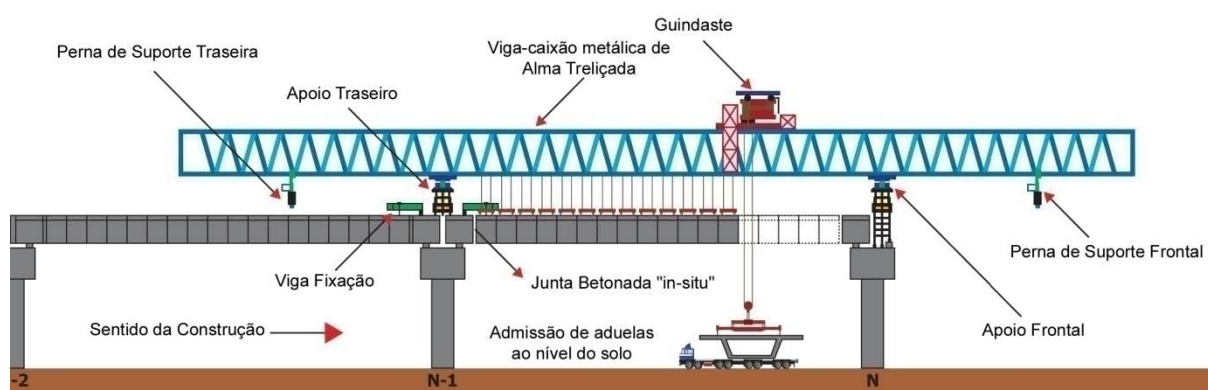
Construção tramo a tramo com recurso a lançadeira.
